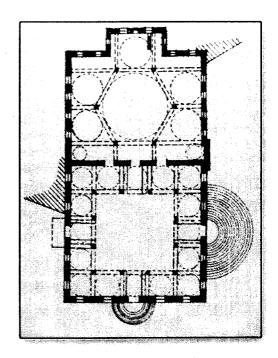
جامع محمد أفندي آلتي بالقاهرة (مسقط أفقي)
